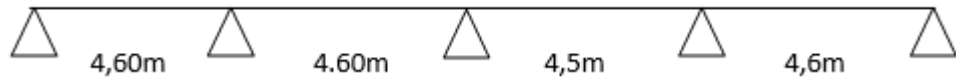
Schéma statique de la poutrelle a 4 travées.
